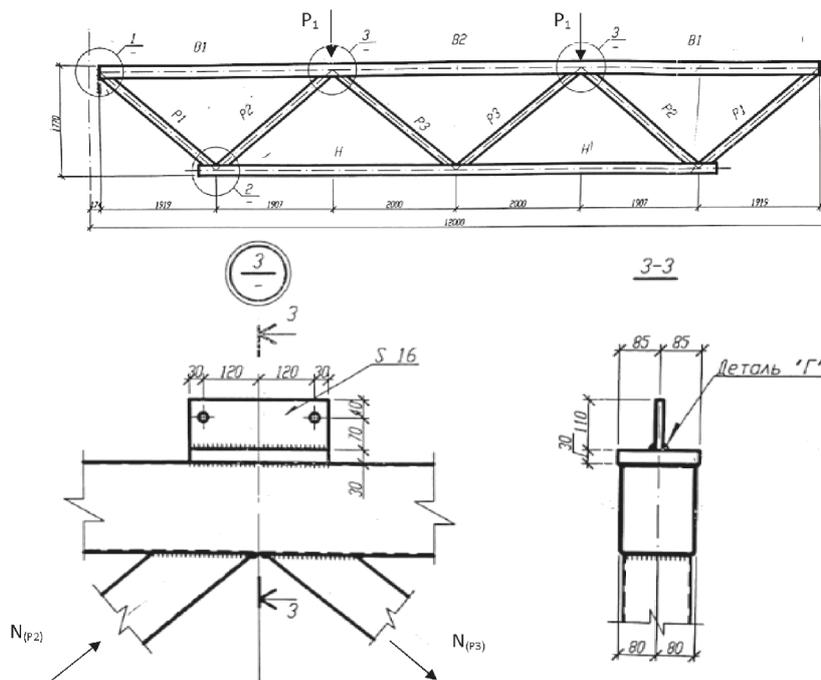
Конструкция подстропильной фермы и ее узлы в месте опирания стропильной фермы
